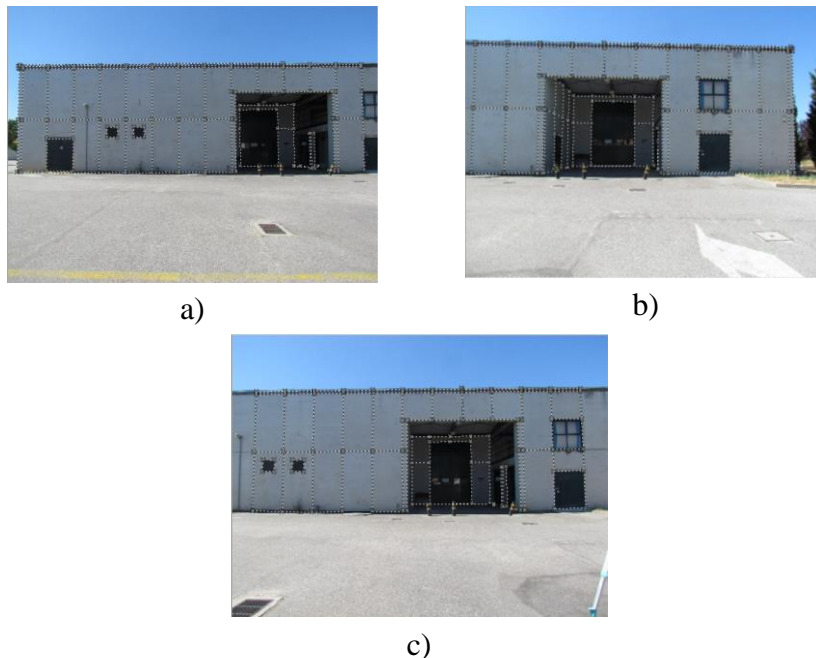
Exemplo do traçado dos contornos da fachada e juntas: a) lado esquerdo da fachada, b) lado direito da fachada e c) centro da fachada
